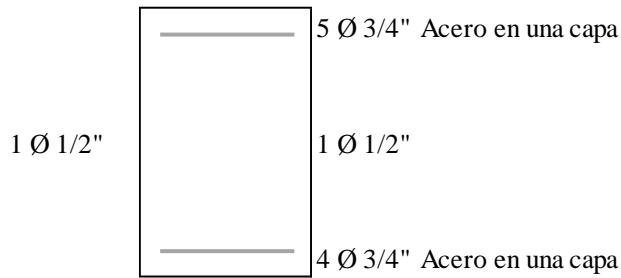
Distribución del Acero longitudinal de VP-202 (40 x 90) - Sistema estructural tradicional.
